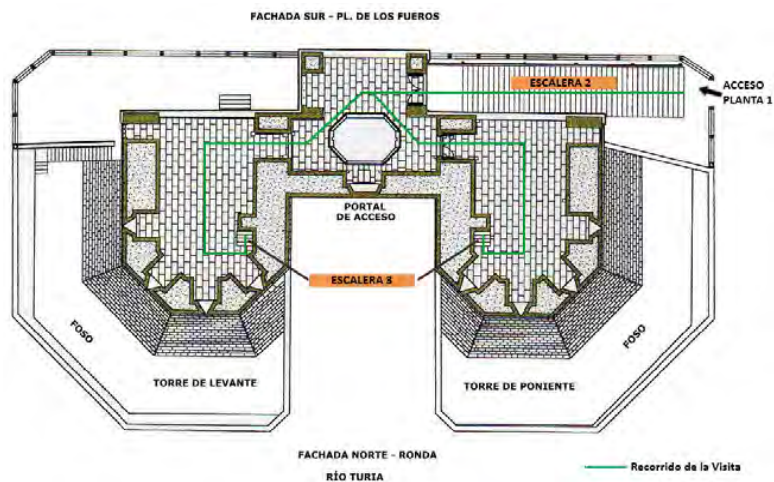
Sección de la primera planta y recorrido (Fuente: www.jdiezarnal.com Plano modificado por el autor)
